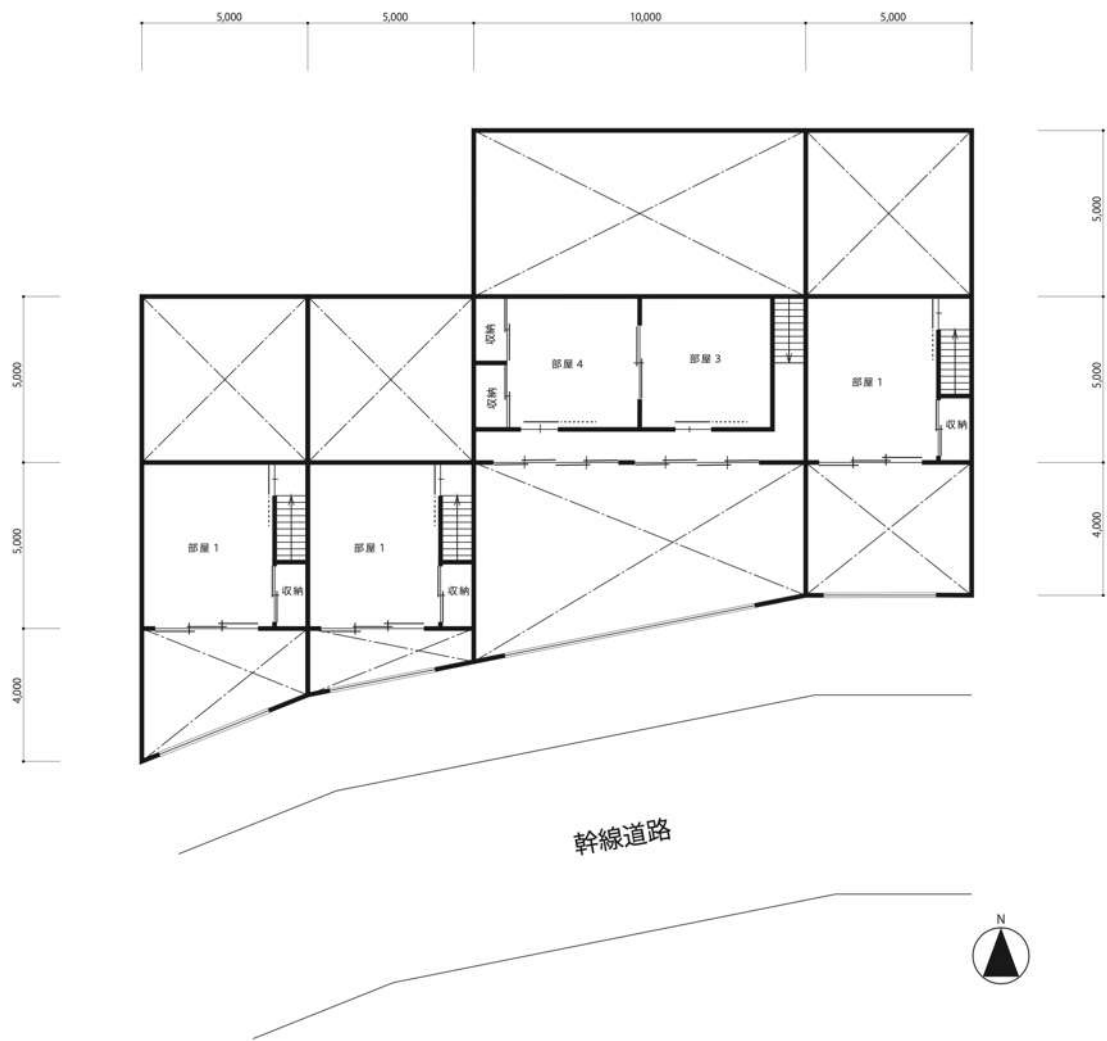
幹線道路（中心街路）を生かした住居 2 階平面図
